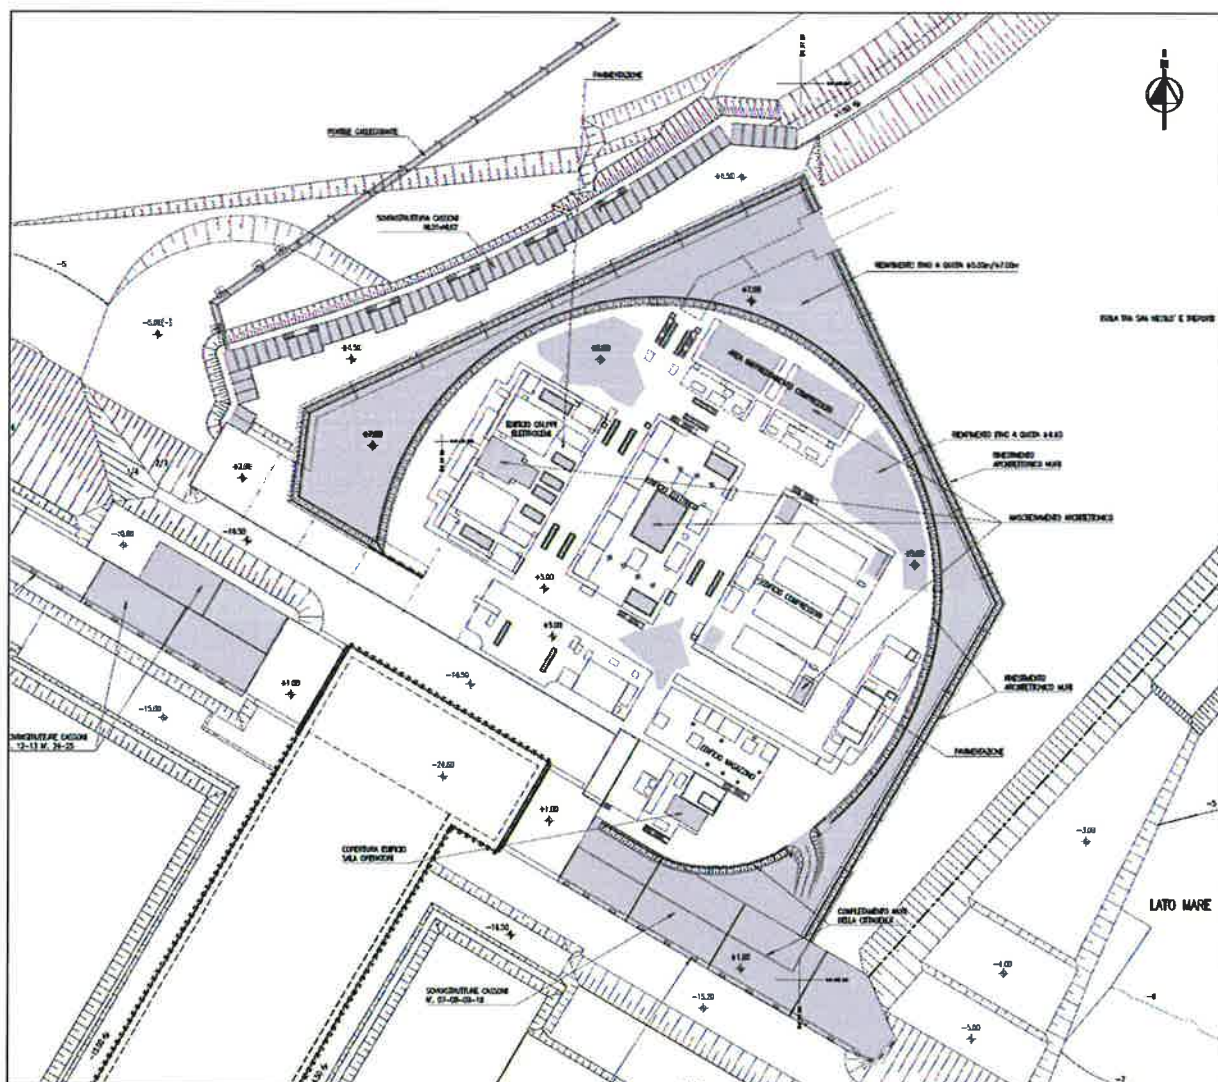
SPALLA NORD, PIANTA E SEZIONE DELLE OPERE DELLA QUINTA WBE DELLA SPALLA NORD
